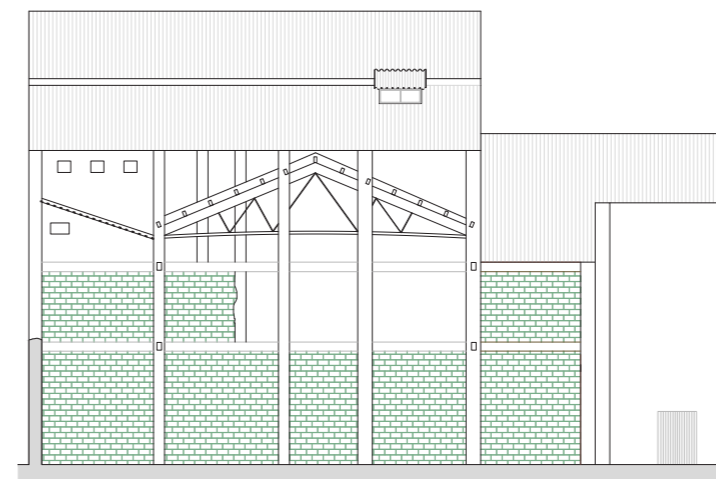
Alzado norte en el que se ha grafiado de color verde el cerramiento realizado a base de ladrillo hueco colocado a panderete.
